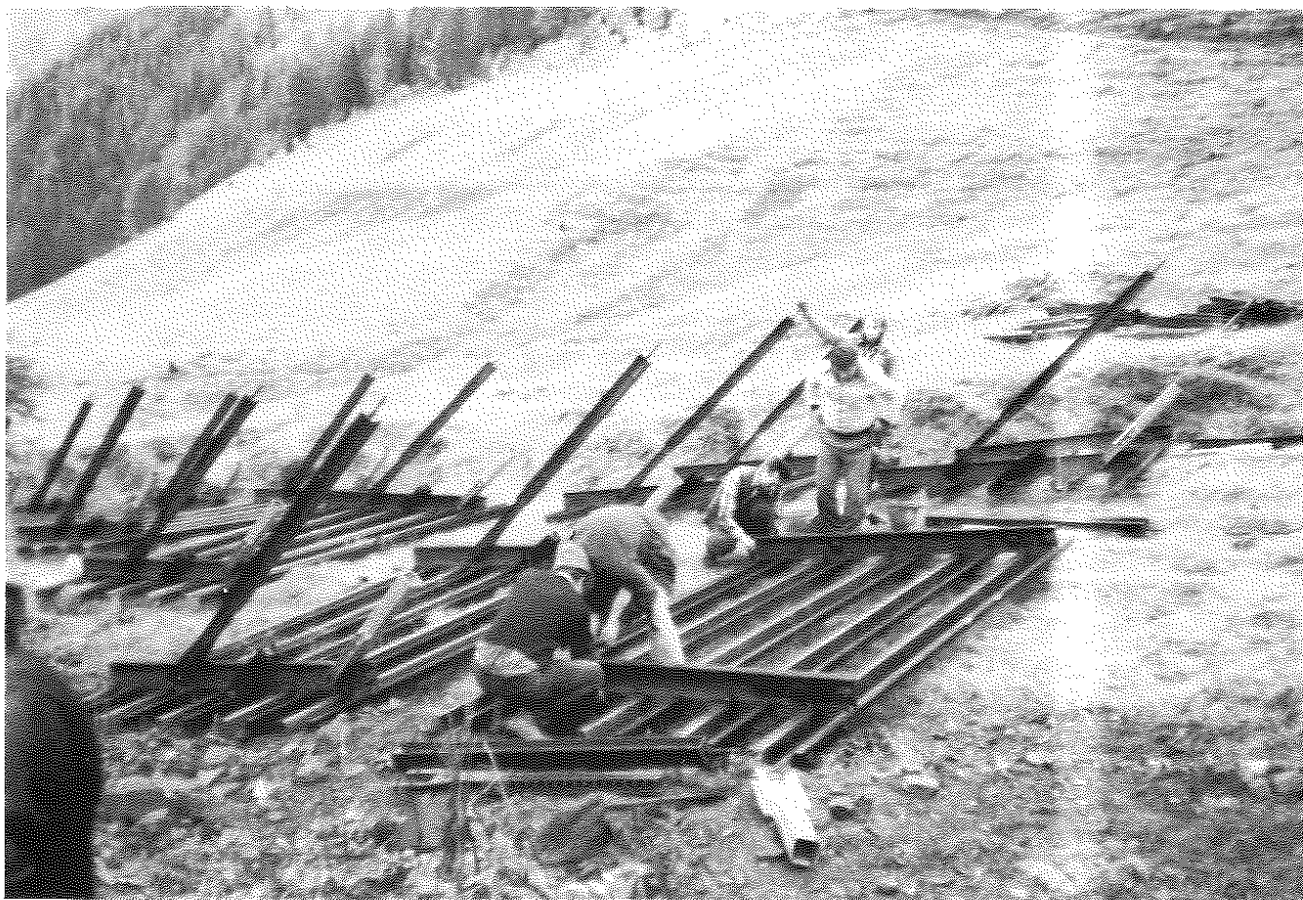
Premontaggio agevole delle strutture Mair-HG in cantiere a valle.
